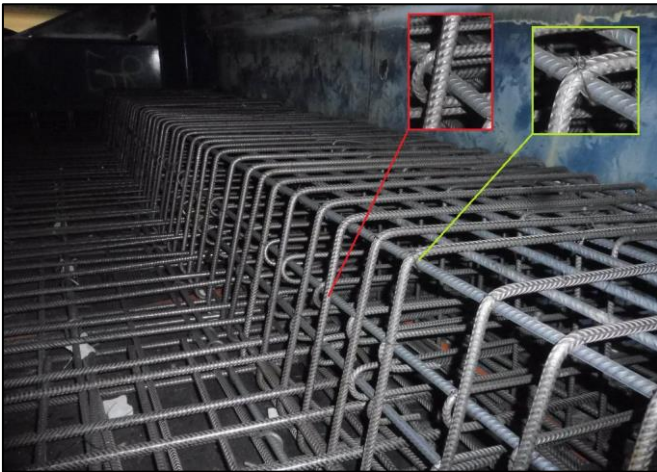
Vérification de la présence de ligature sur le ferrailage d'une pièce avant bétonnage.
